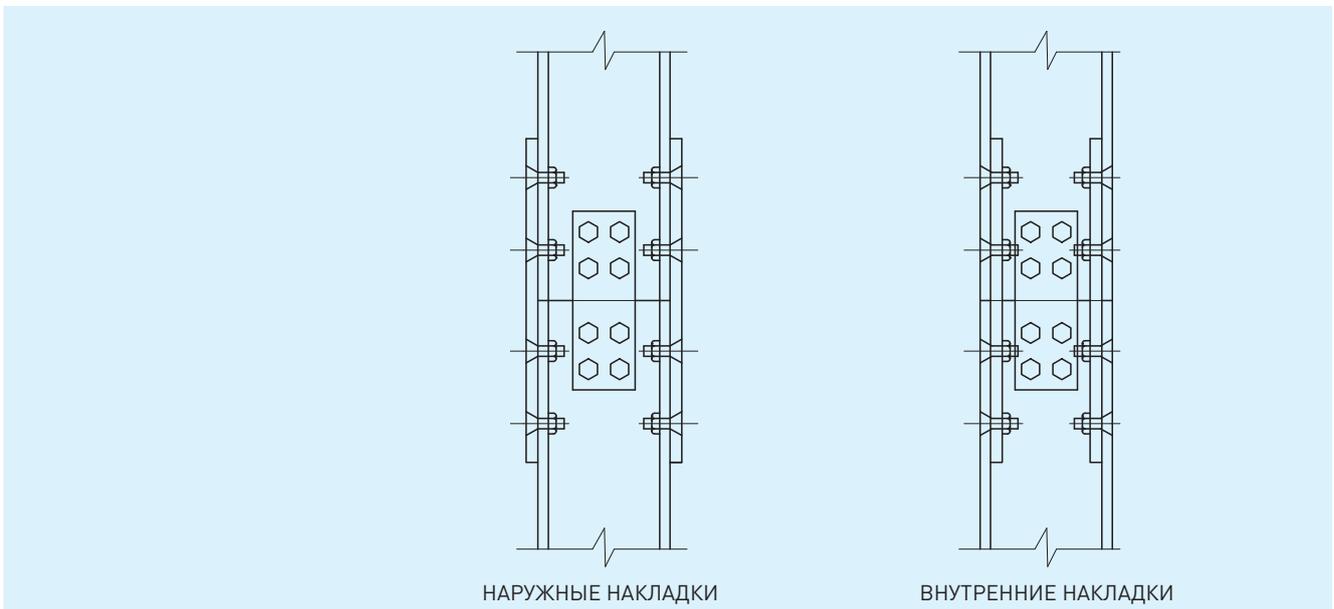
Монтажный стык колонны по высоте на болтах с потайными головками
